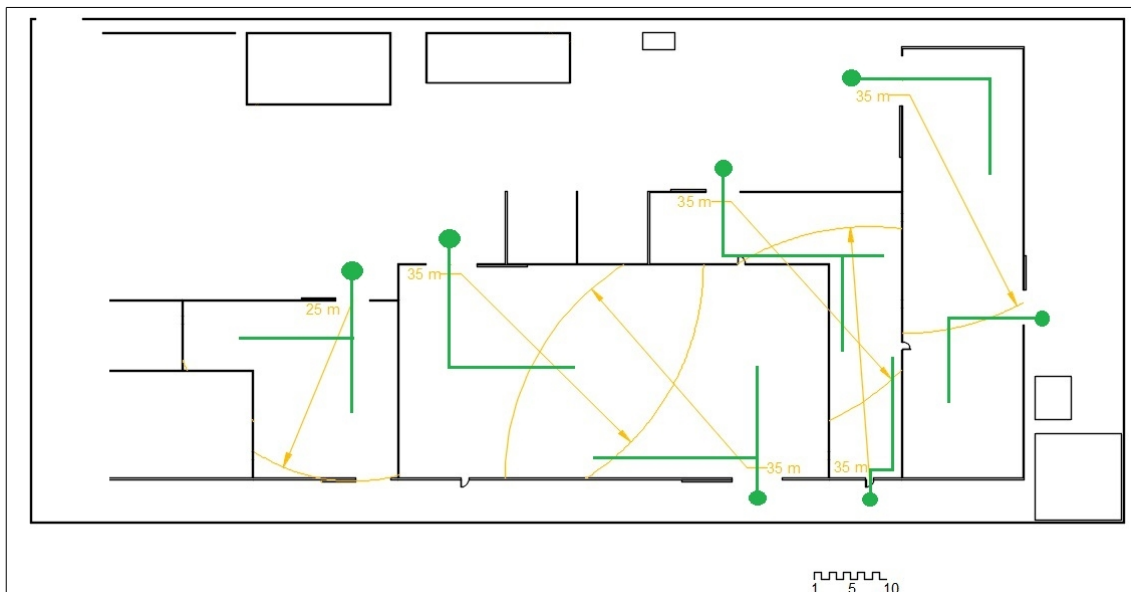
Plano de las salidas y los recorridos de evacuación. Fuente propia.
